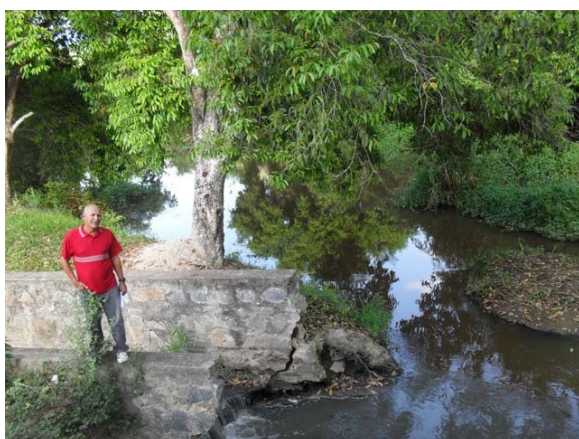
Trecho final do Canal revestido e aberto conduzindo águas pluviais e esgotos – lançamento no Rio Água Branca.
